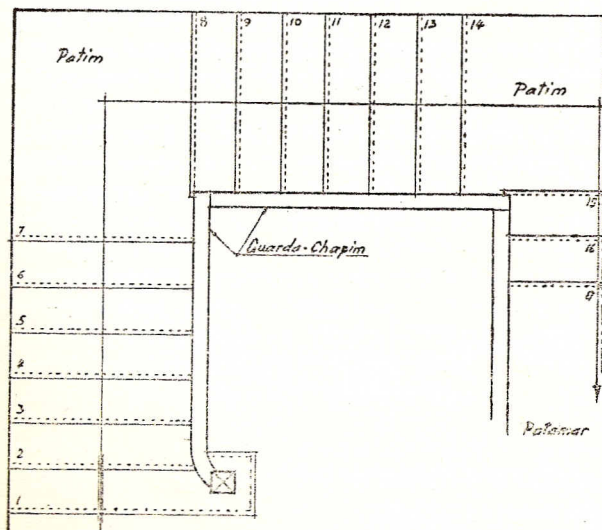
PLANTA DA ESCADA DE ÂNGULOS RECTOS
